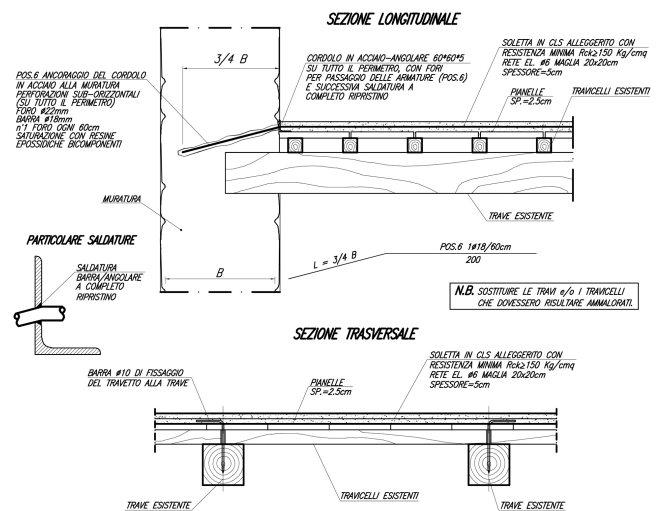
a – Collegamento della soletta in calcestruzzo alleggerito armato con connettori d'acciaio alle orditure portanti
